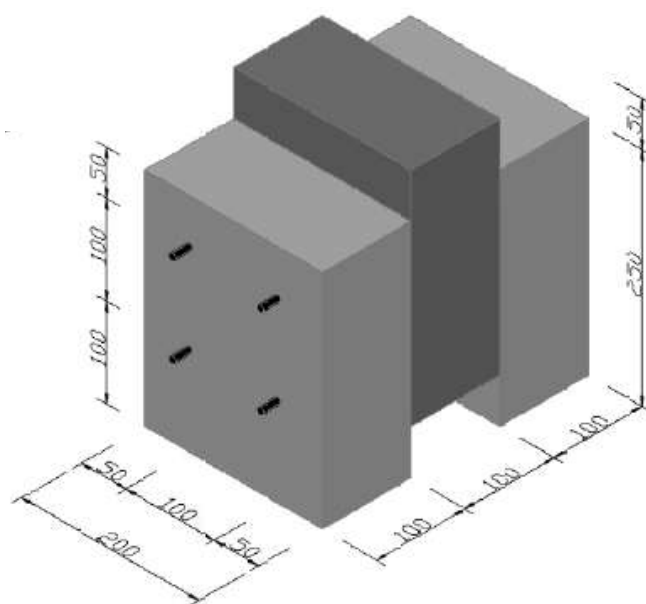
Dimensões (em mm) do provete de duplo corte, com armadura de ligação.
